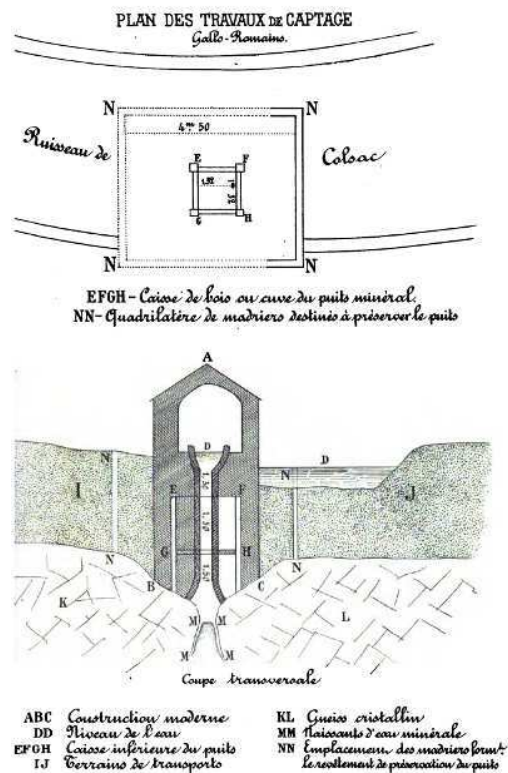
Planimetria e sezione del pozzo di captazione di Coren (da BOUDET 1889, tav. I).
